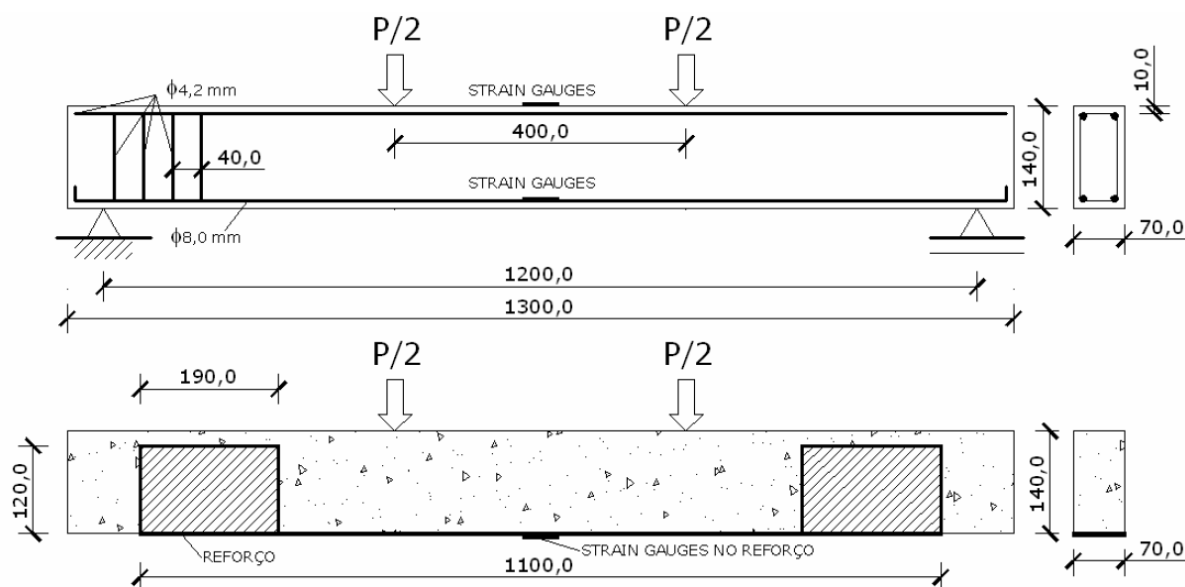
Detalhes e esquema de carregamento das vigas do grupo IIA (Meneghetti, 2007)
